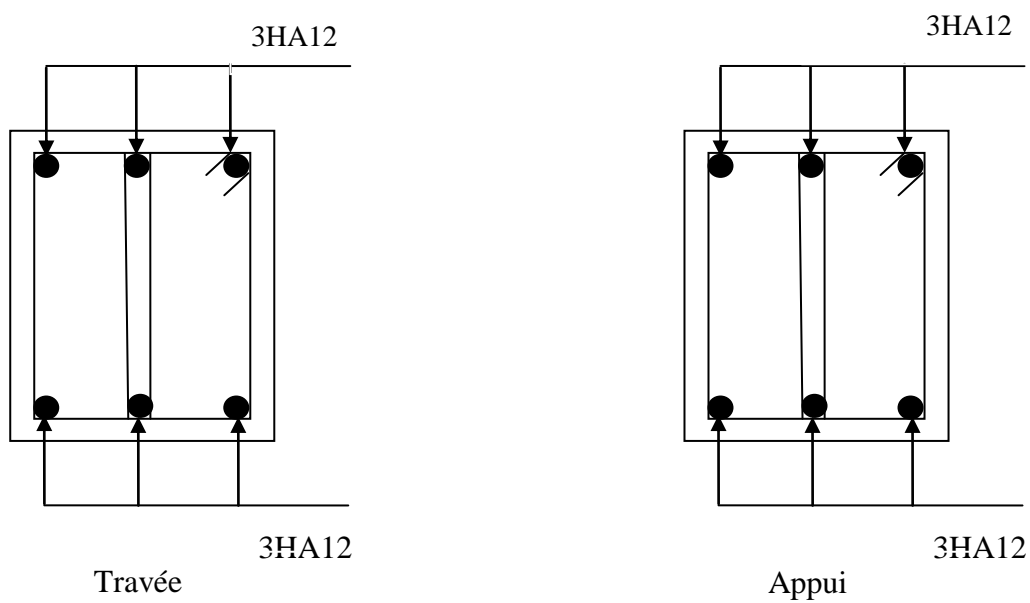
Schéma de ferrailage de la poutre secondaire (30×30) de la terrasse
